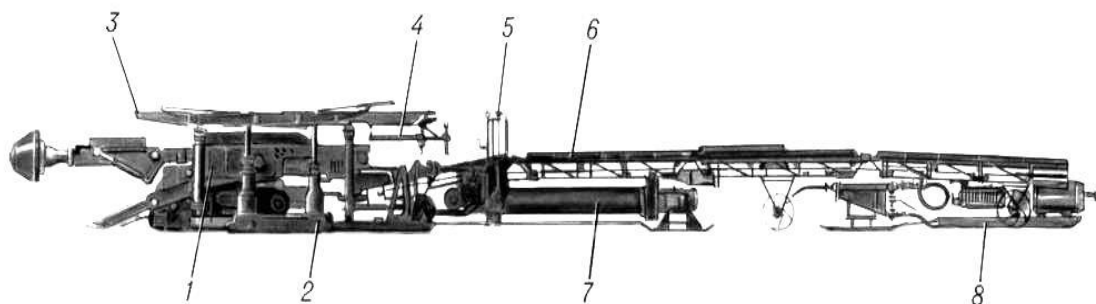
Проведение подземной выработки проходческим комбайном [Tunneling with roadheader]
